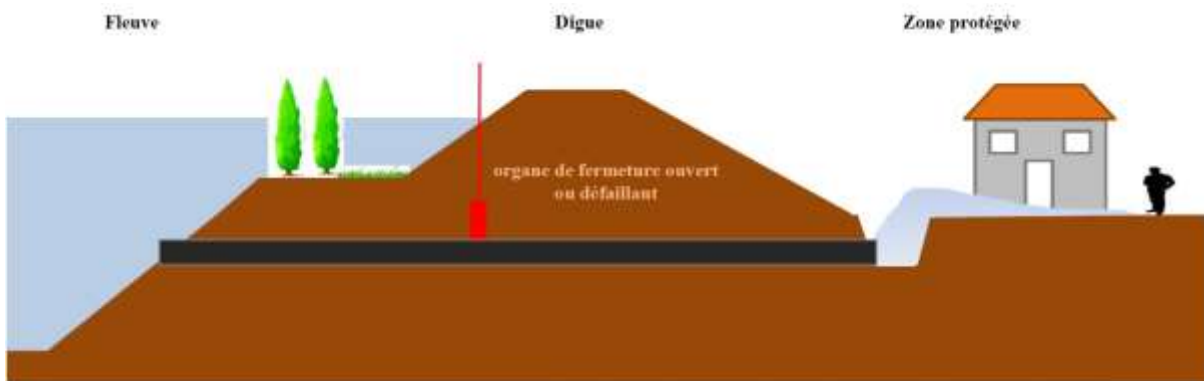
Cas n°3 : Inondation de la zone protégée par défaillance d'un ouvrage hydraulique traversant
